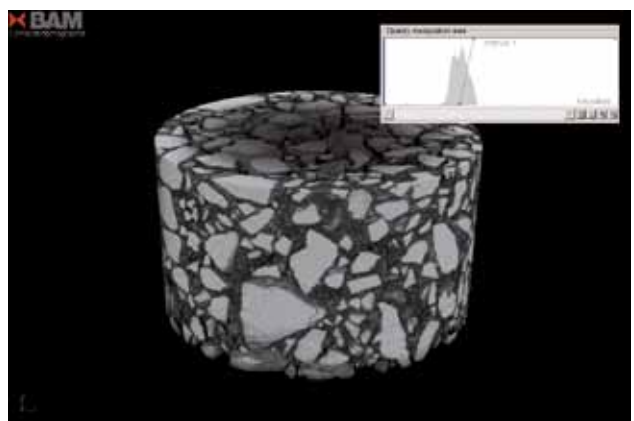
Weitere Oberfläche eines Bohrzyinders aus Beton mit Parameterangaben.
